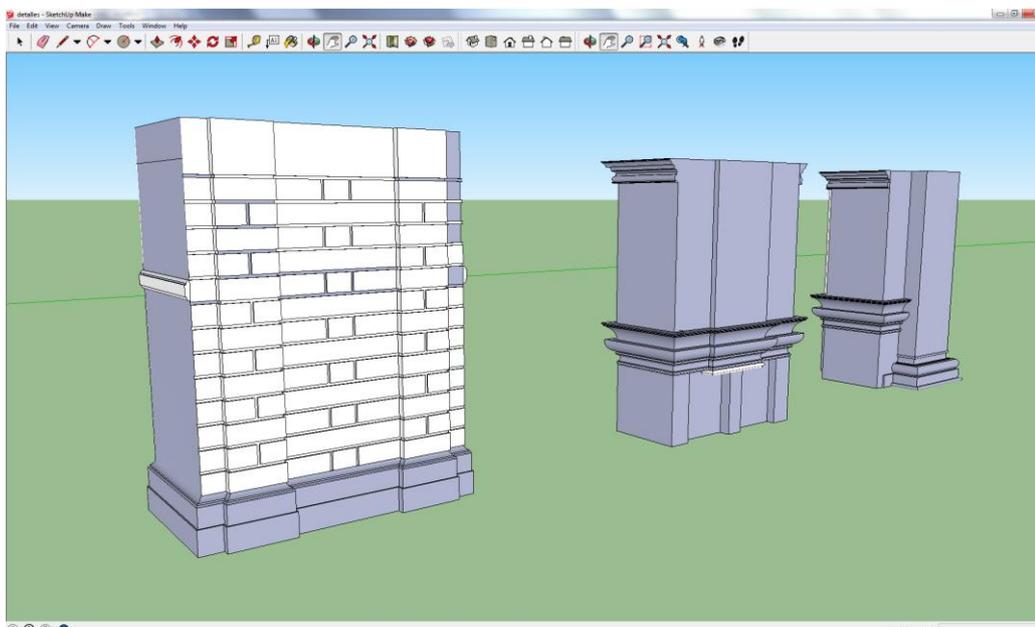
Detalle de las Columnas – “Iglesia San Francisco”
